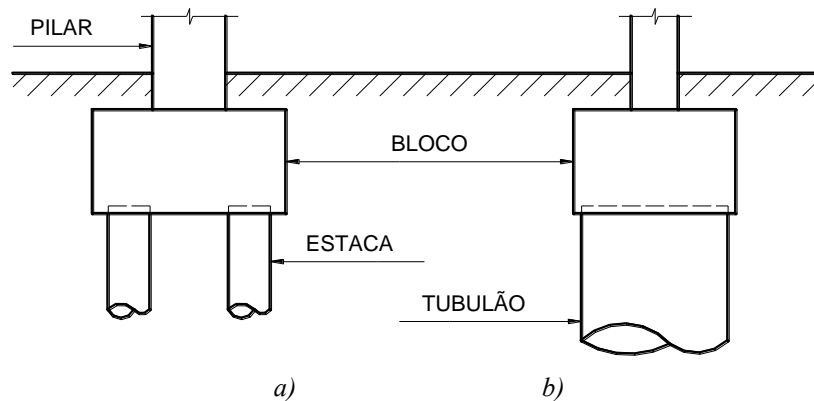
Bloco sobre: a) estacas e b) tubulão.
